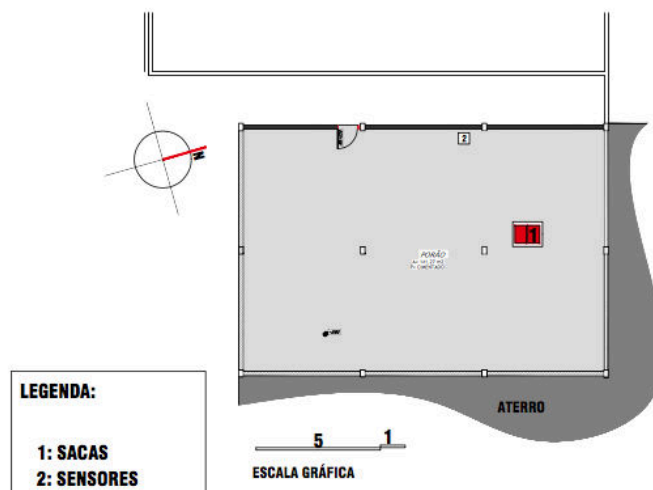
planta baixa do modelo empírico porão (subsolo) (MEP).
